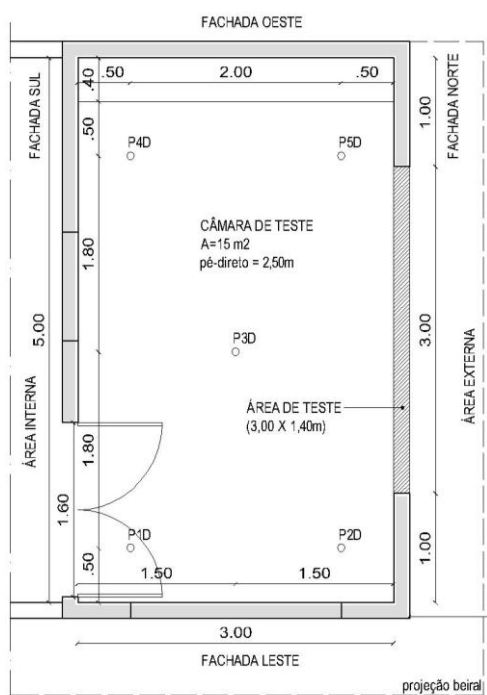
Planta da sala de teste com detalhe para a fachada onde serão aplicados os elementos vazados
